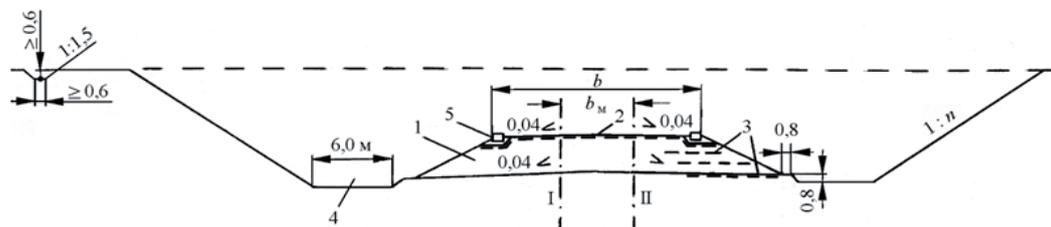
Поперечный профиль выемки в легковетвирующих и выветривающихся скальных грунтах:
